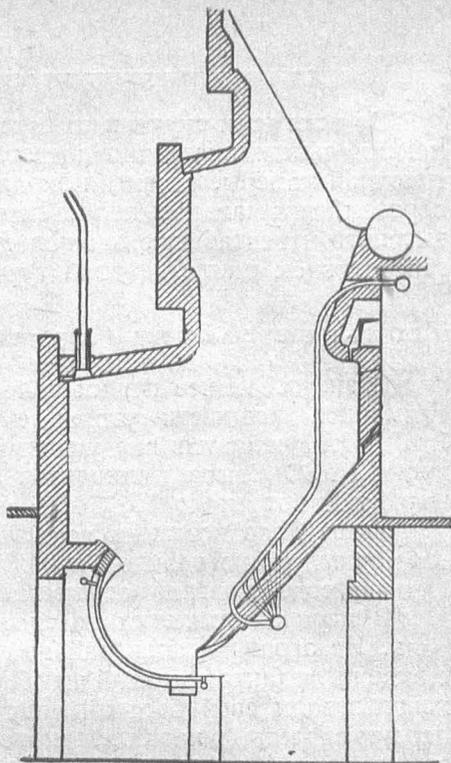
Фонтанная топка для сжигания фрезторфа инж. А. Шершнева
